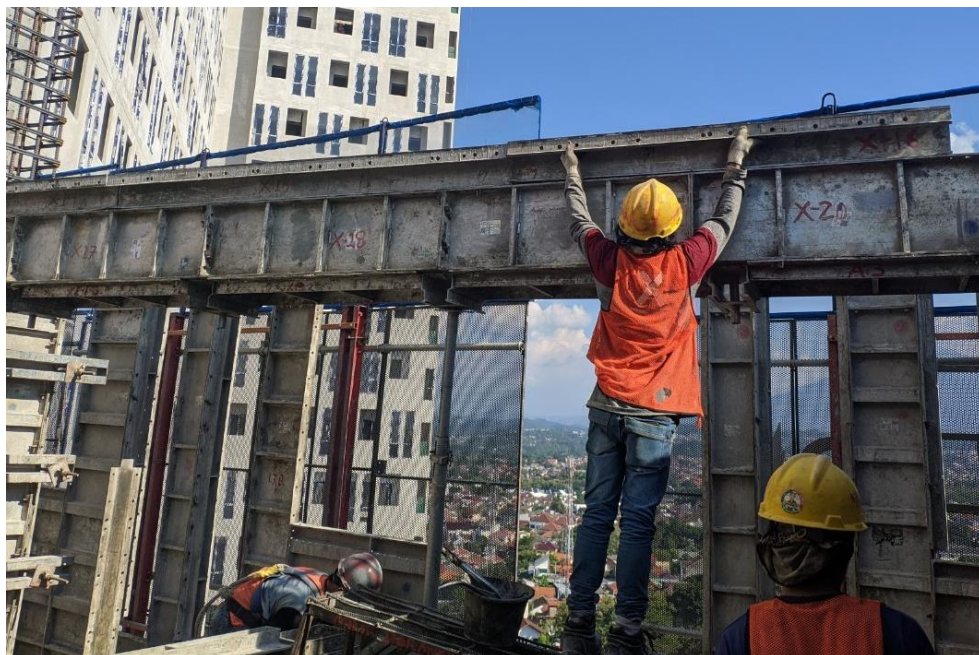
Pemasangan bekisting balok (*beam panel*)
